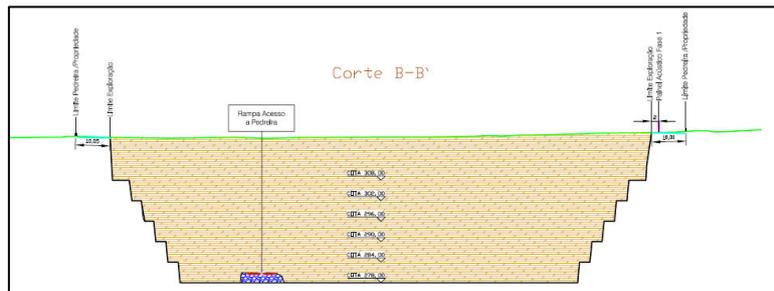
Perfil de exploração - Corte B-B' - com a localização da barreira acústica (Fonte: Elementos Complementares, março de 2022)
